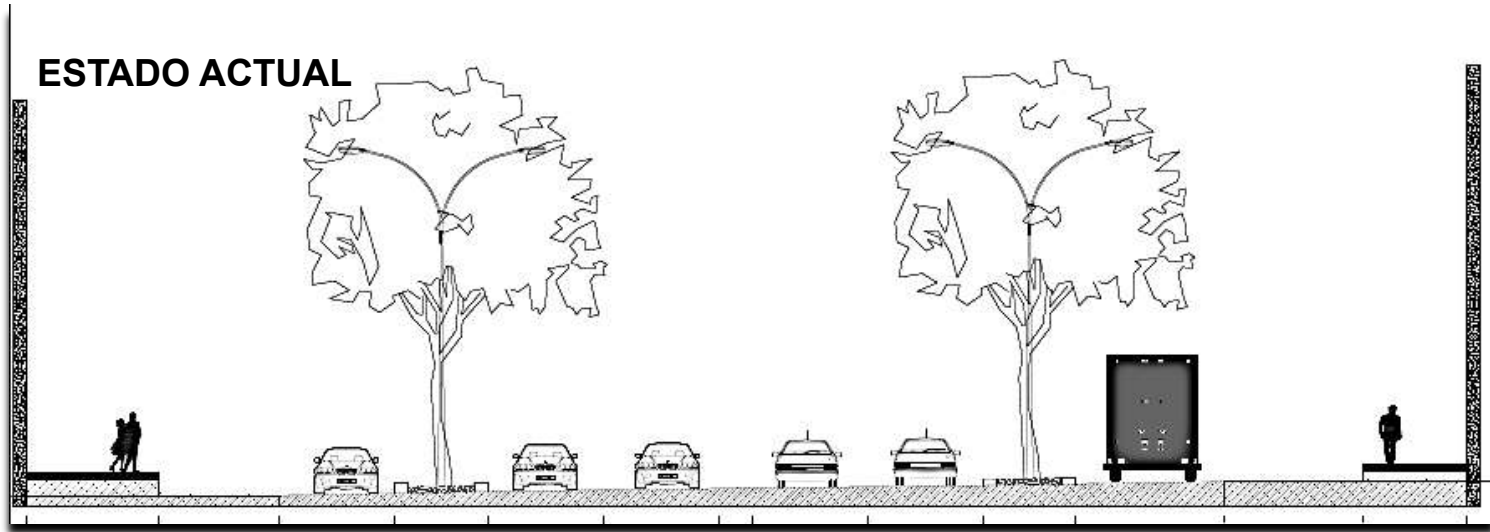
Sección actual de Av. Madero Poniente con calle Marcos Carrillo
